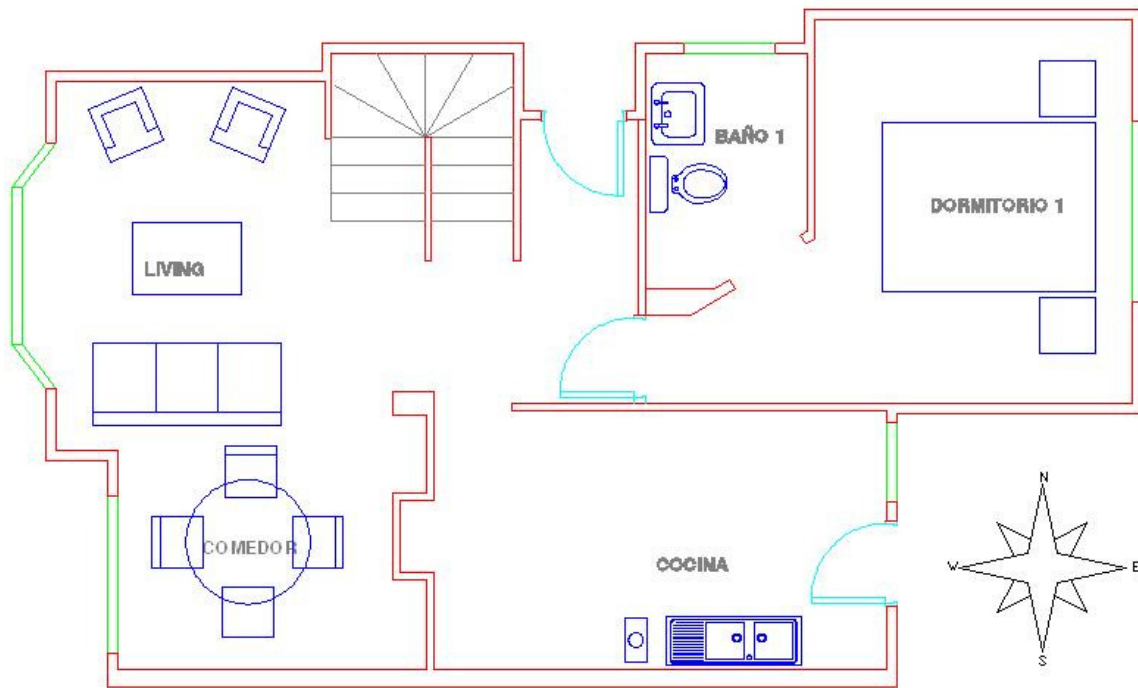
Planta primer piso de la vivienda 3 (modelo Tenglo).
